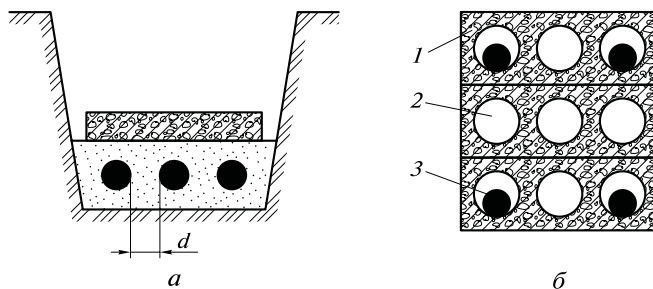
Прокладка кабелей в земляной траншее (а) и бетонном блоке (б): 1 — железобетонная панель; 2 — канал; 3 — кабель
